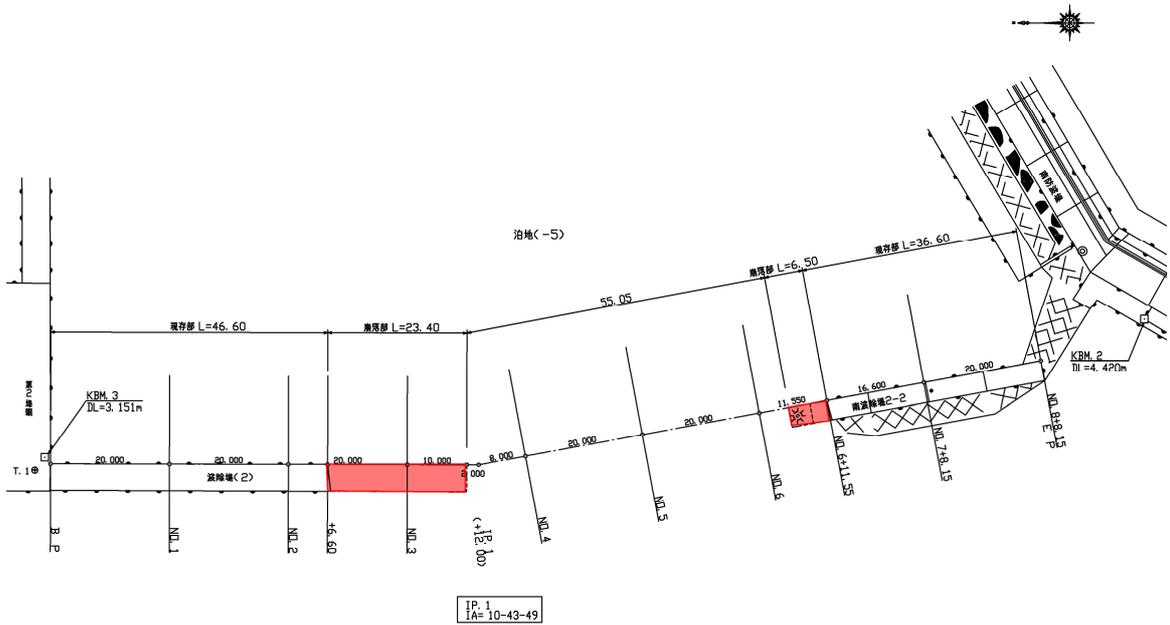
121 No.5 大洗港区_北波除堤の平面図 (被災後)
